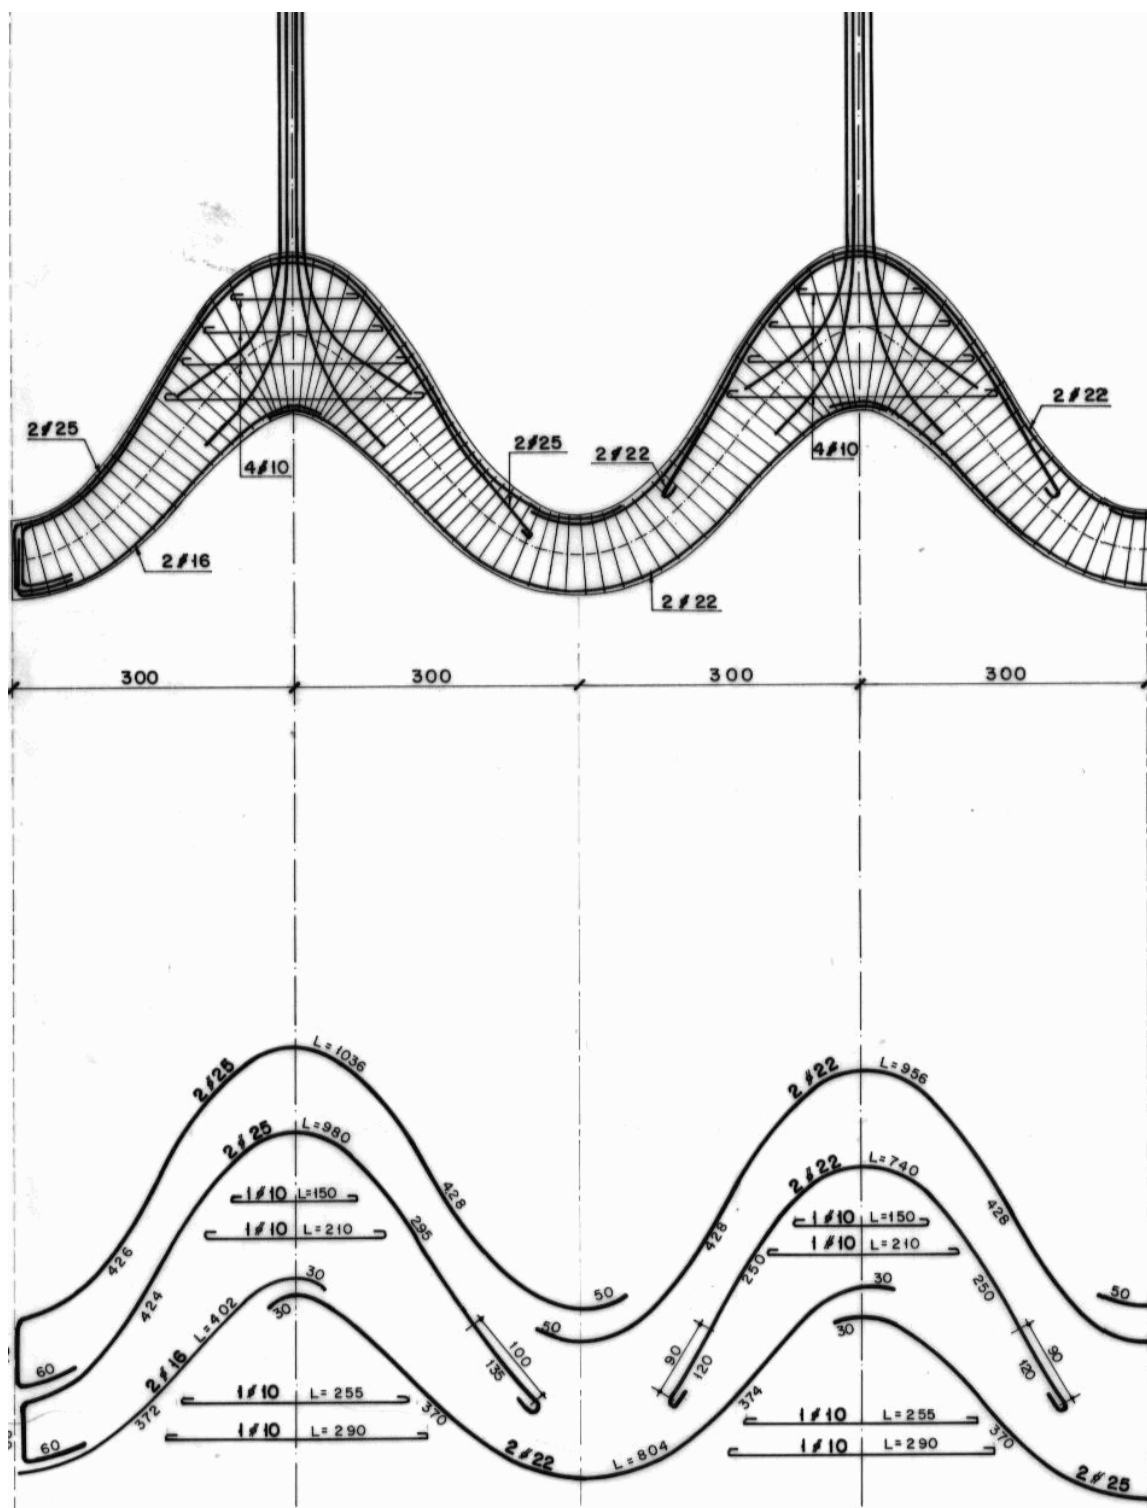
Detalhes construtivos de Atlantida: armadura da viga de borda.
